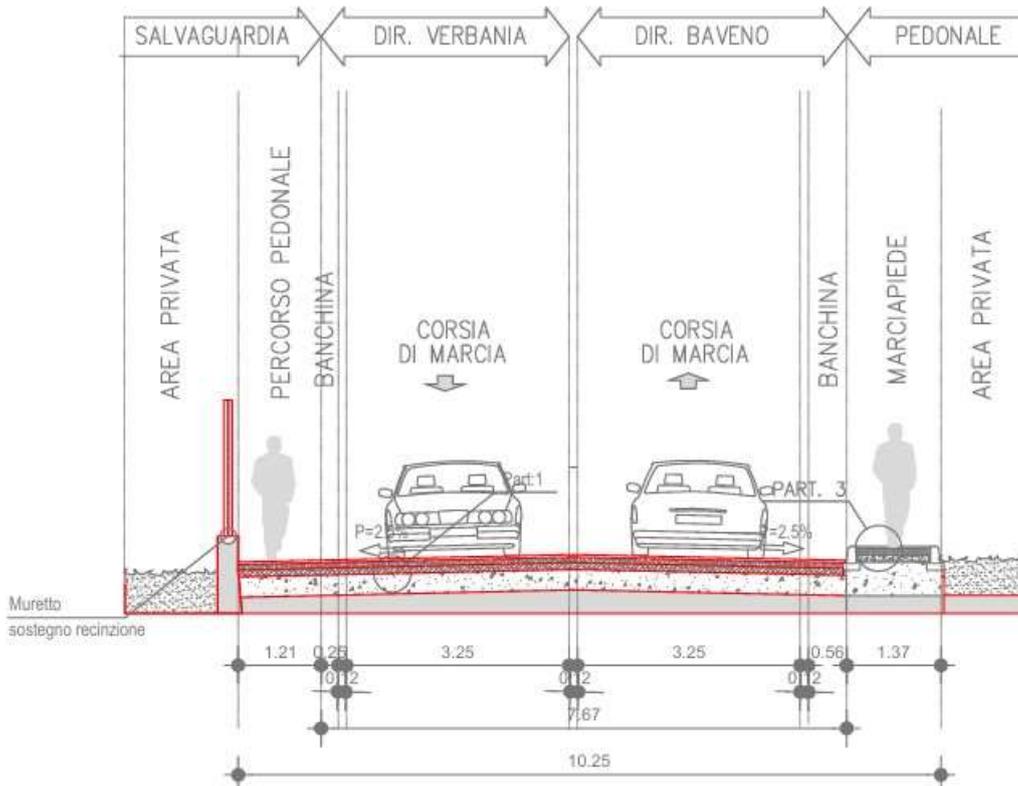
SEZIONE 5 DI PROGETTO - TRATTO STRADALE ALL'ALTEZZA DI VIA MAZZINI
